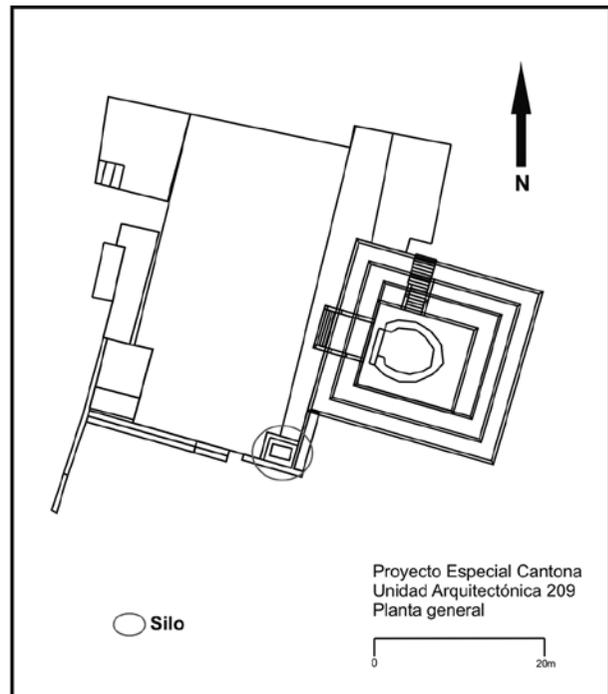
Planta de la unidad arquitectónica 209, indicando ubicación del silo. Fuente: Proyecto Especial Cantona.
